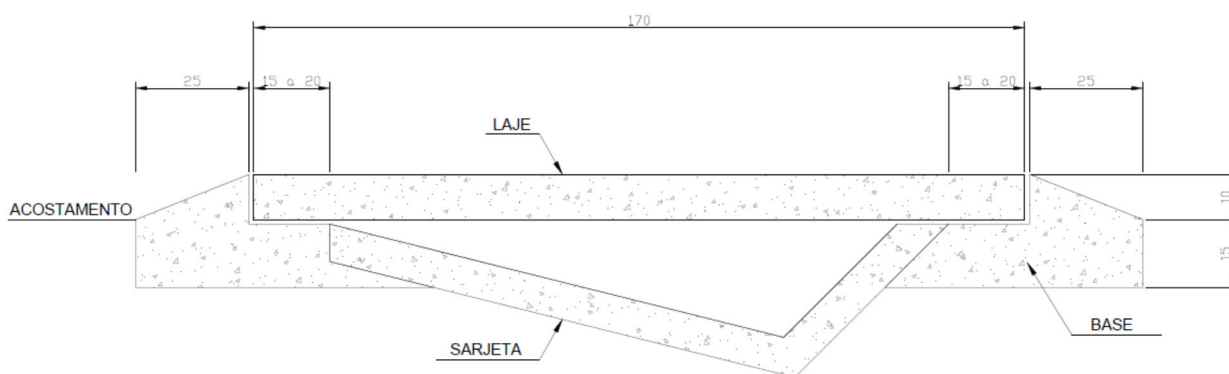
Seção transversal do dispositivo TSS-Tipo 6.
